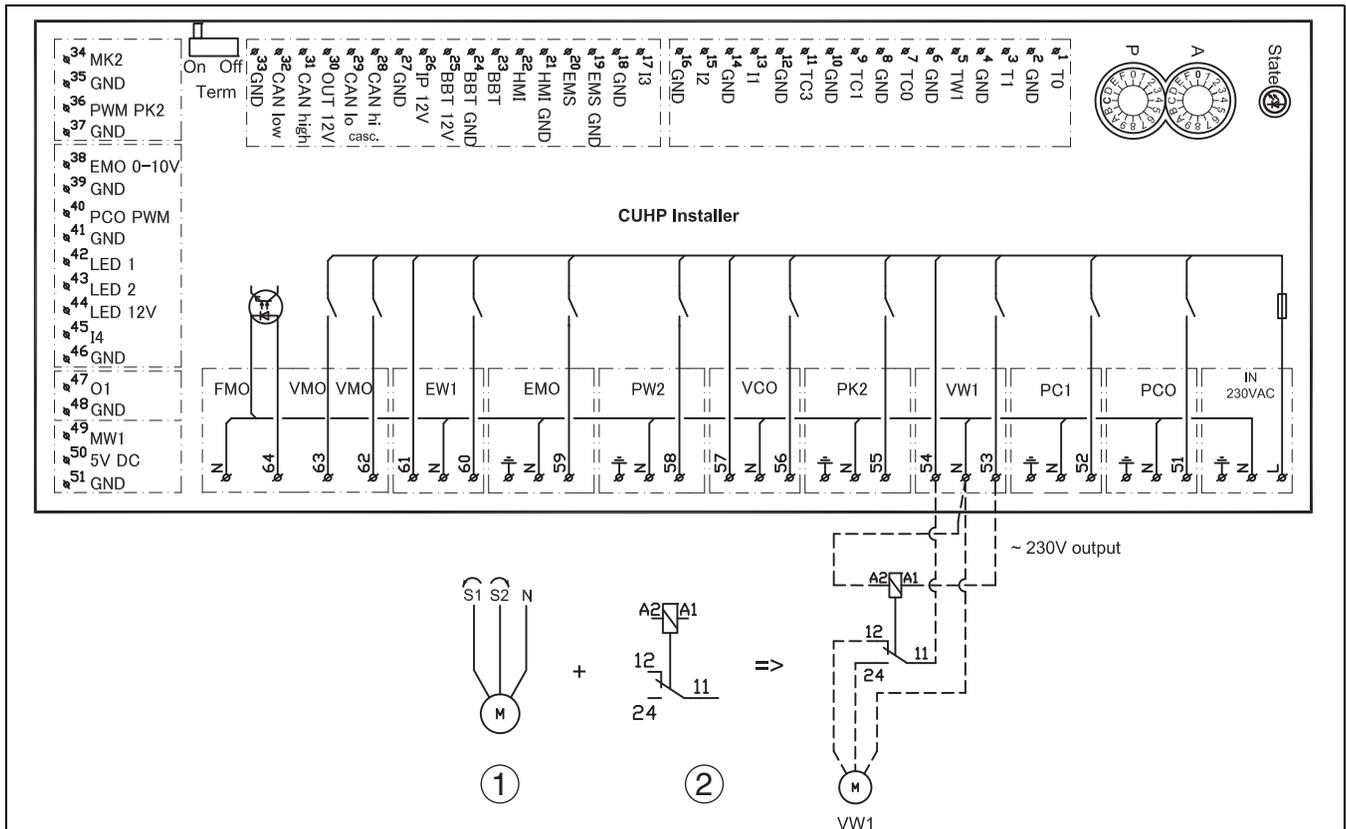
Installazione alternativa valvola di commutazione a 3 vie
